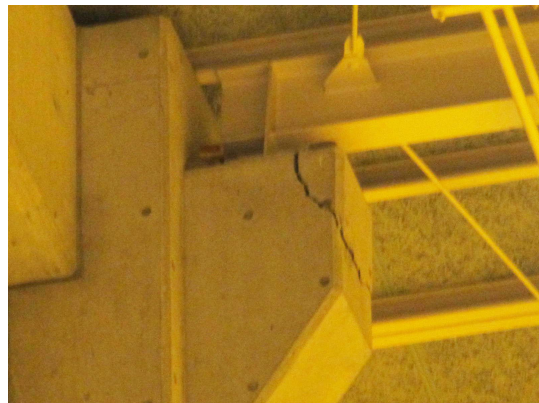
体育館Bの屋根支承部のコンクリートのひび割れ
